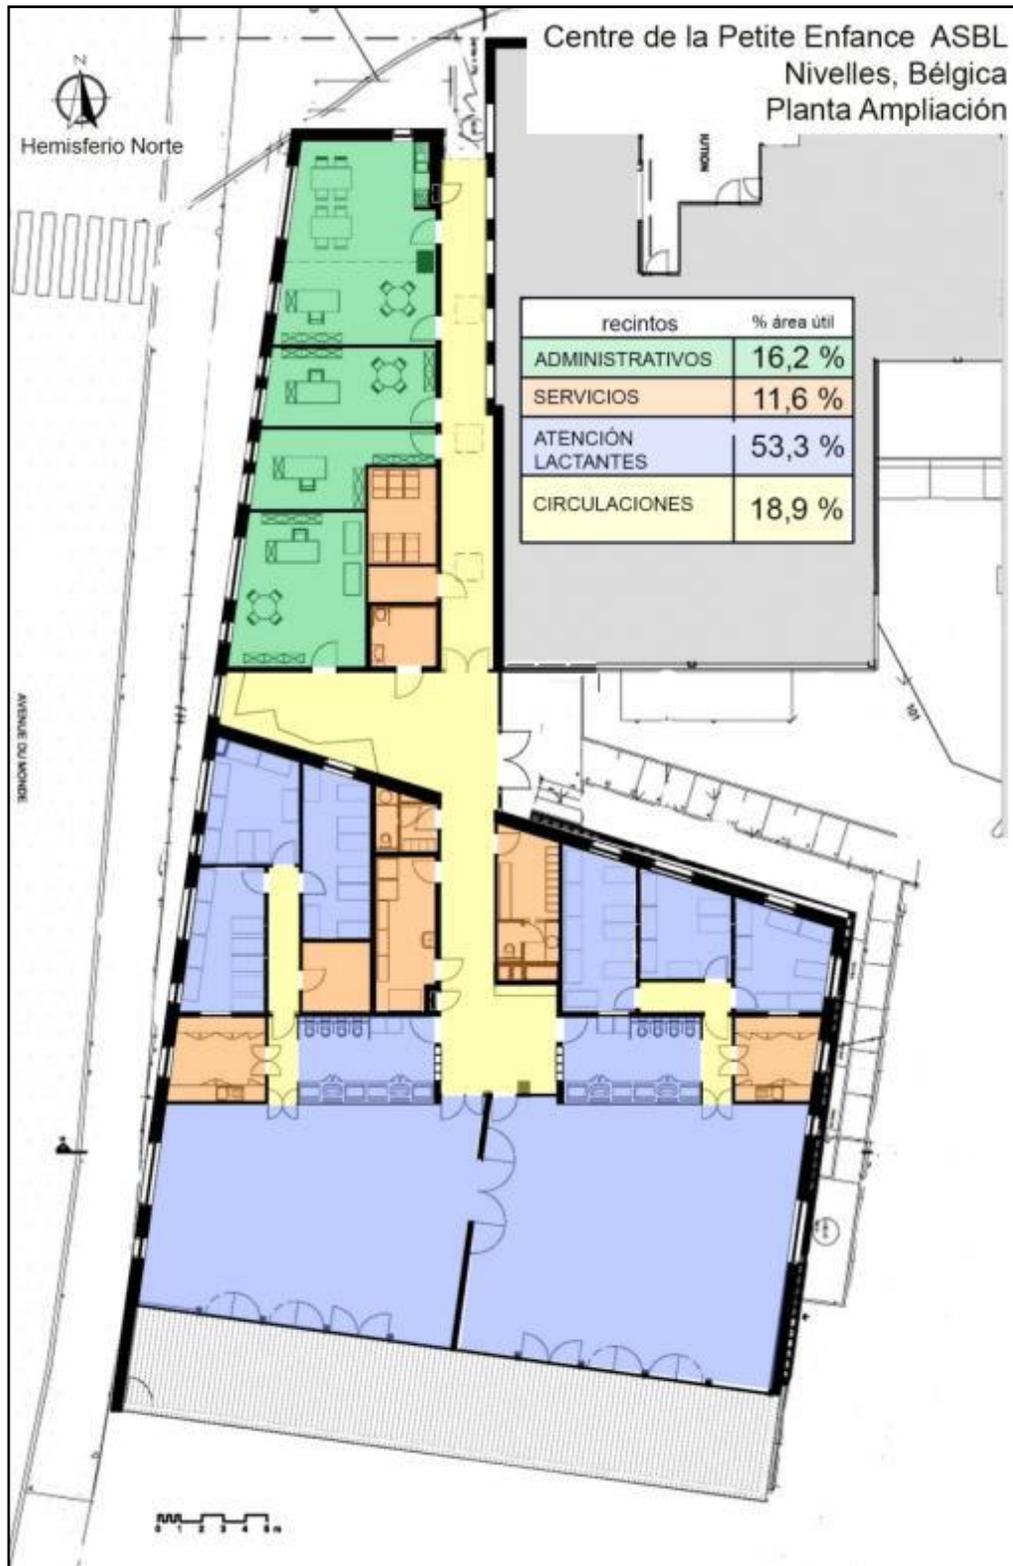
Planta guardería infantil Nivelles, Bélgica.
